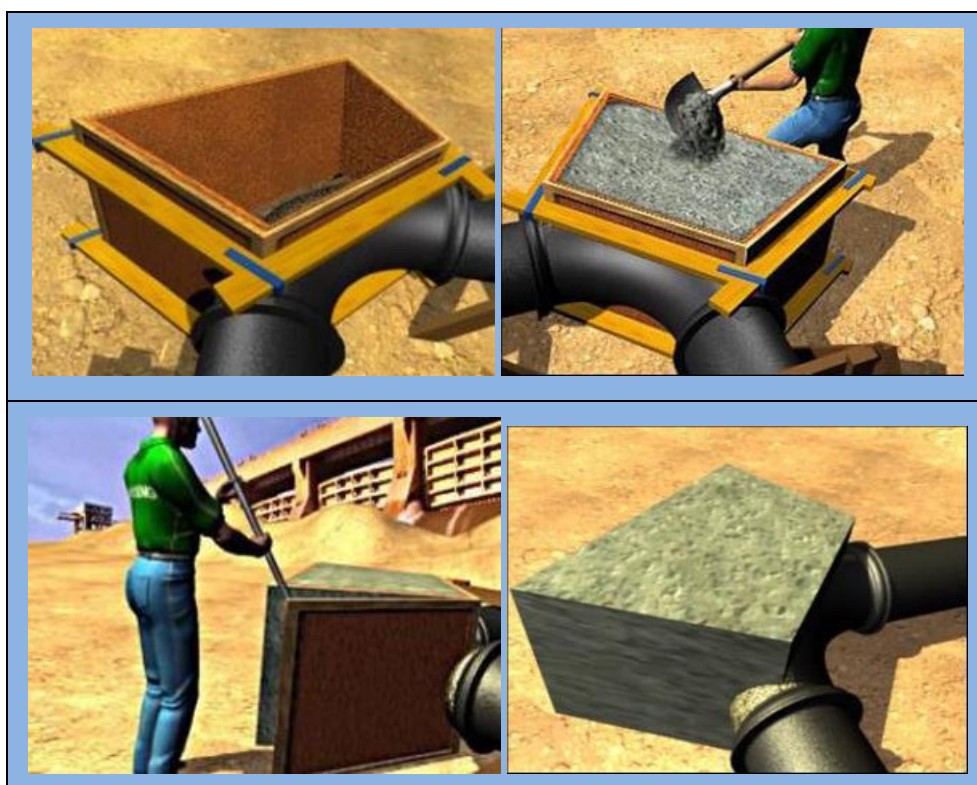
Ilustração da construção dos blocos de ancoragem adutora.
